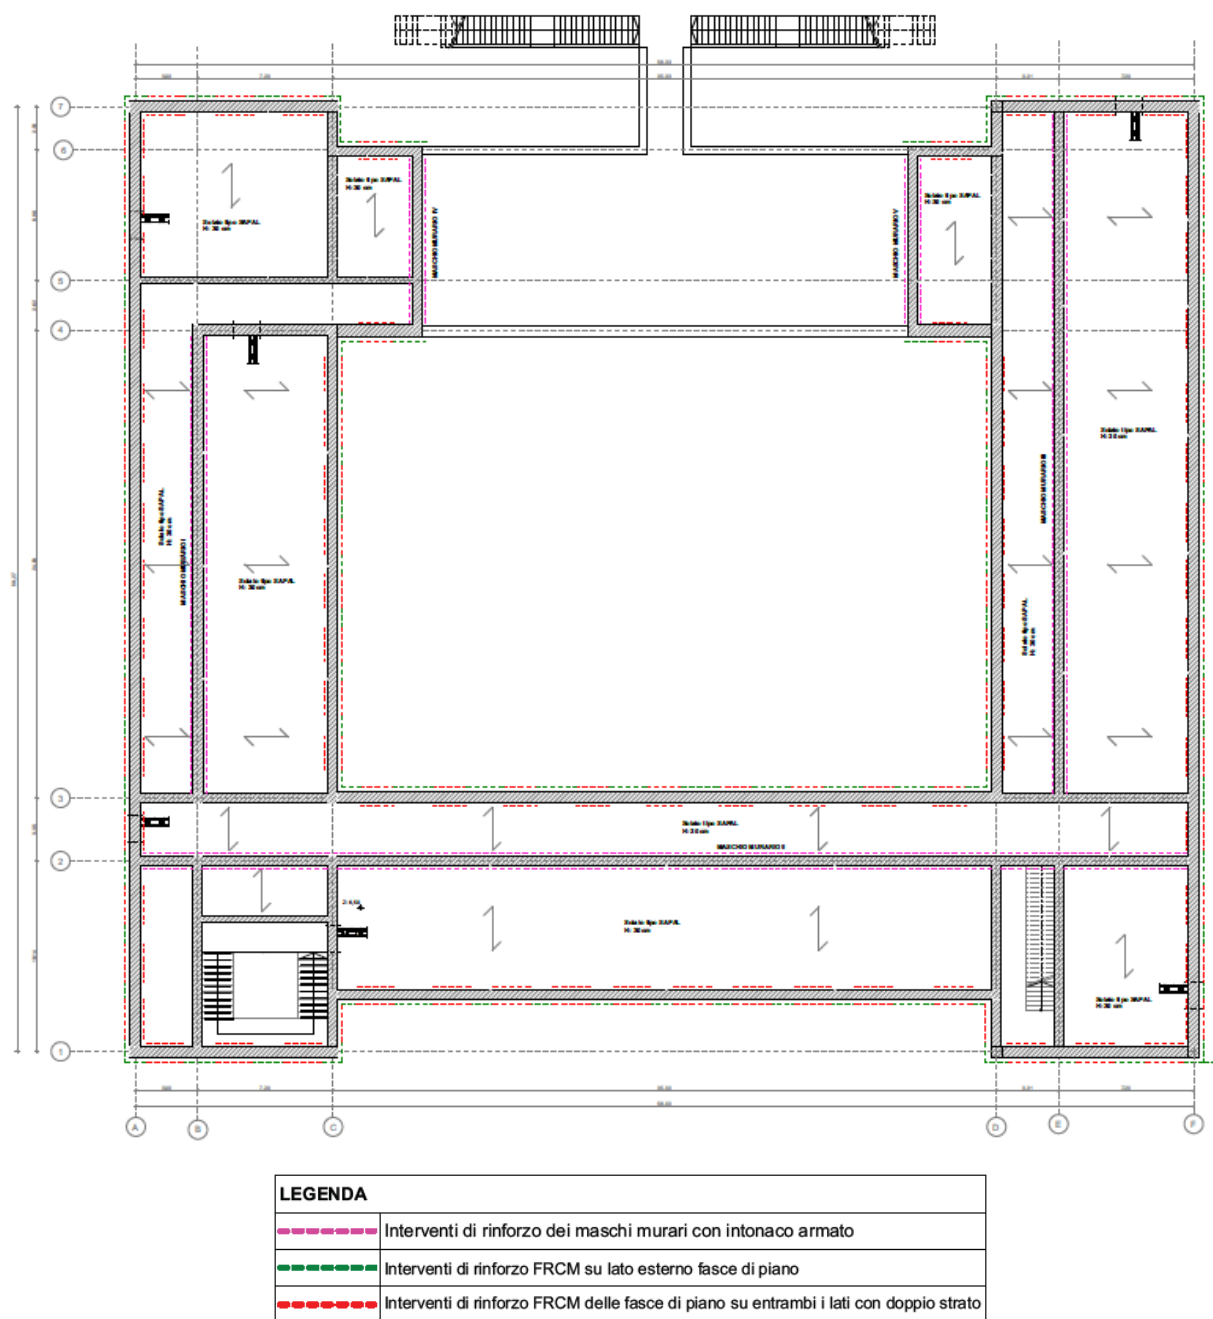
Pianta carpenteria stato di progetto – Piano primo
